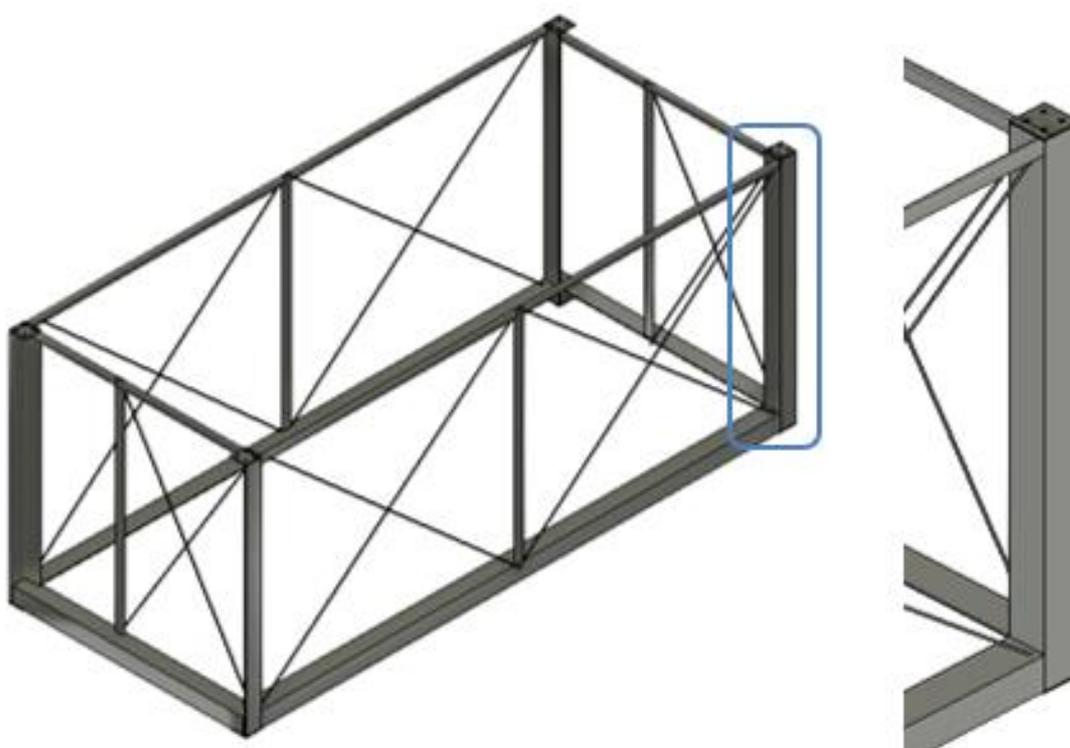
Chapas de apoio nos pilares do módulo (à esquerda) e pormenor construtivo (à esquerda)
